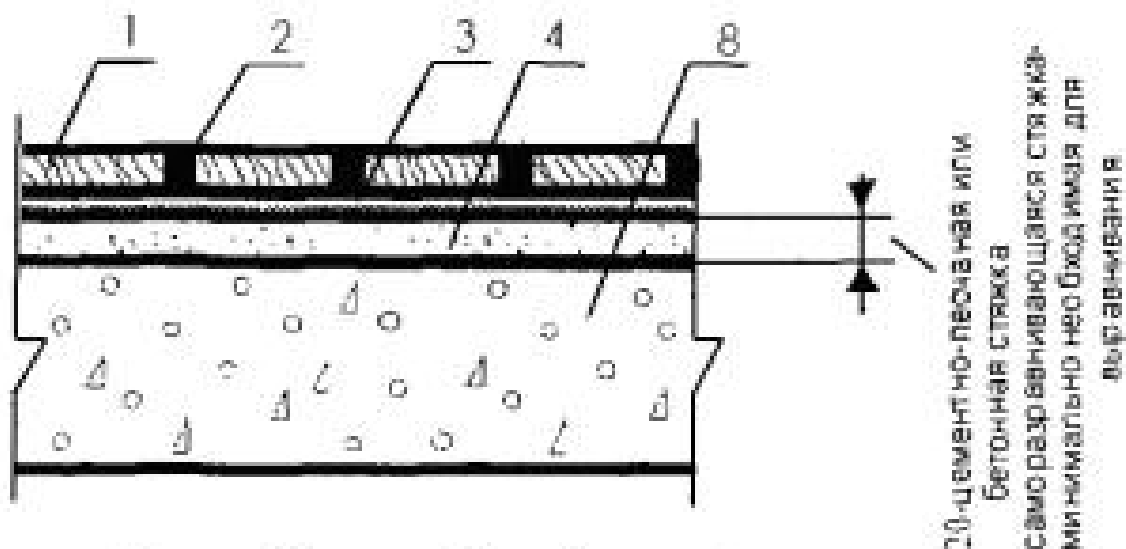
Конструктивные схемы полов с покрытием из ламината по плите перекрытия с монолитной цементно-песчаной или гипсовой стяжкой
